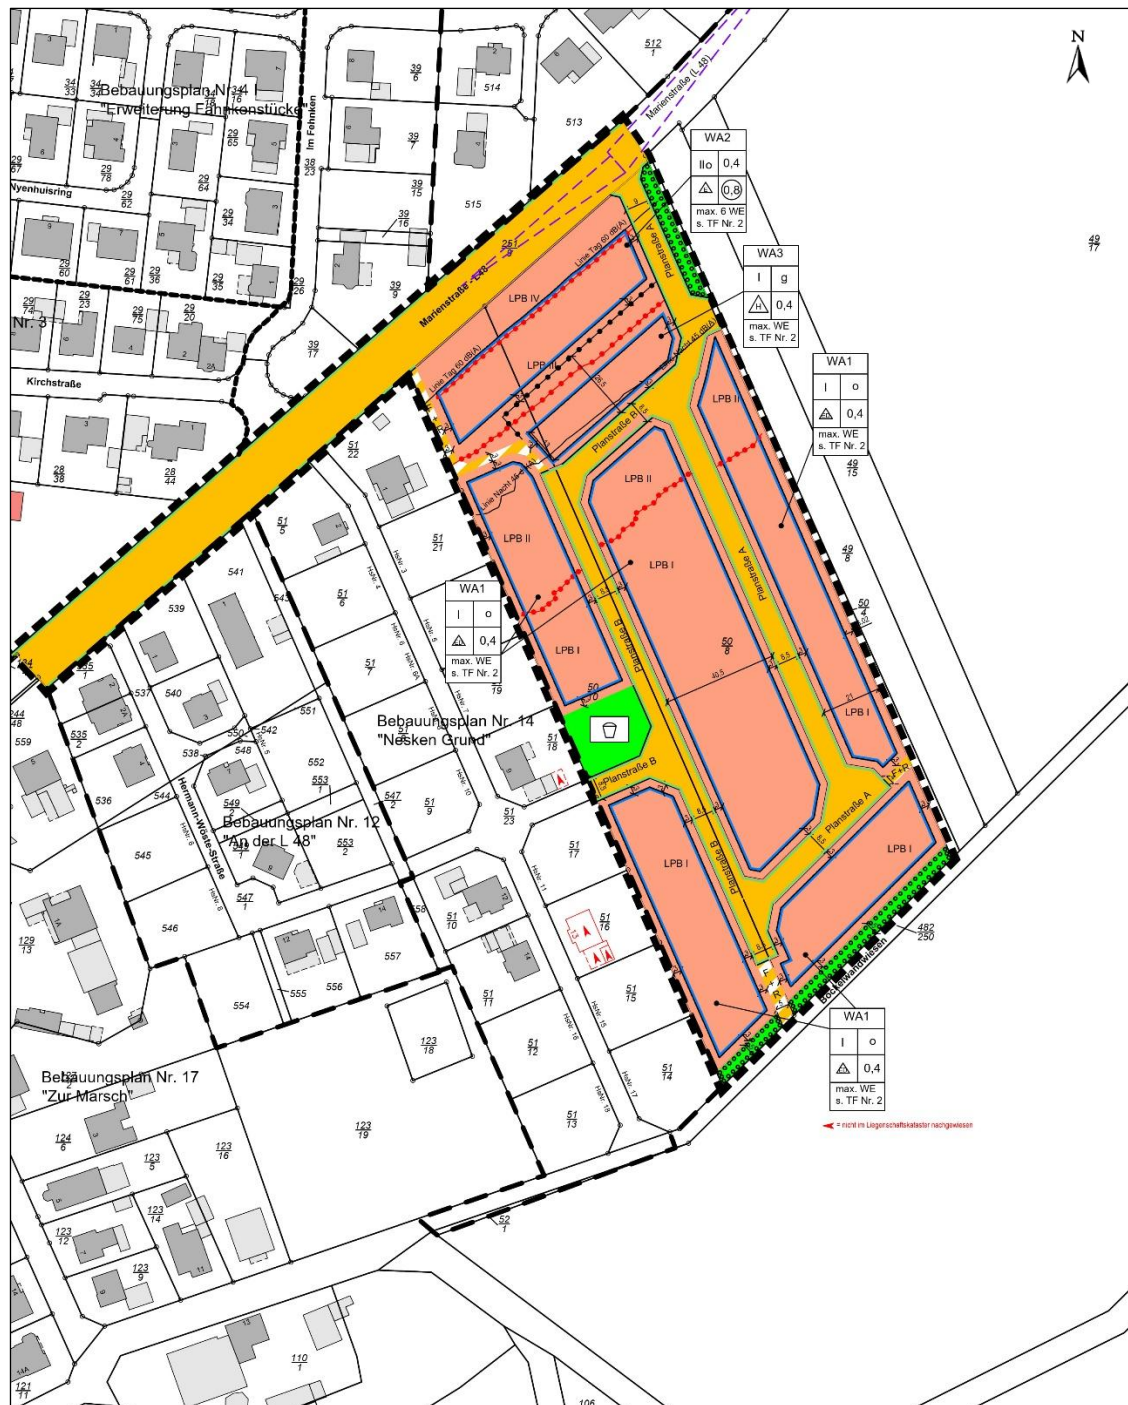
Planzeichnung zum Bebauungsplan (Entwurf) /9/
